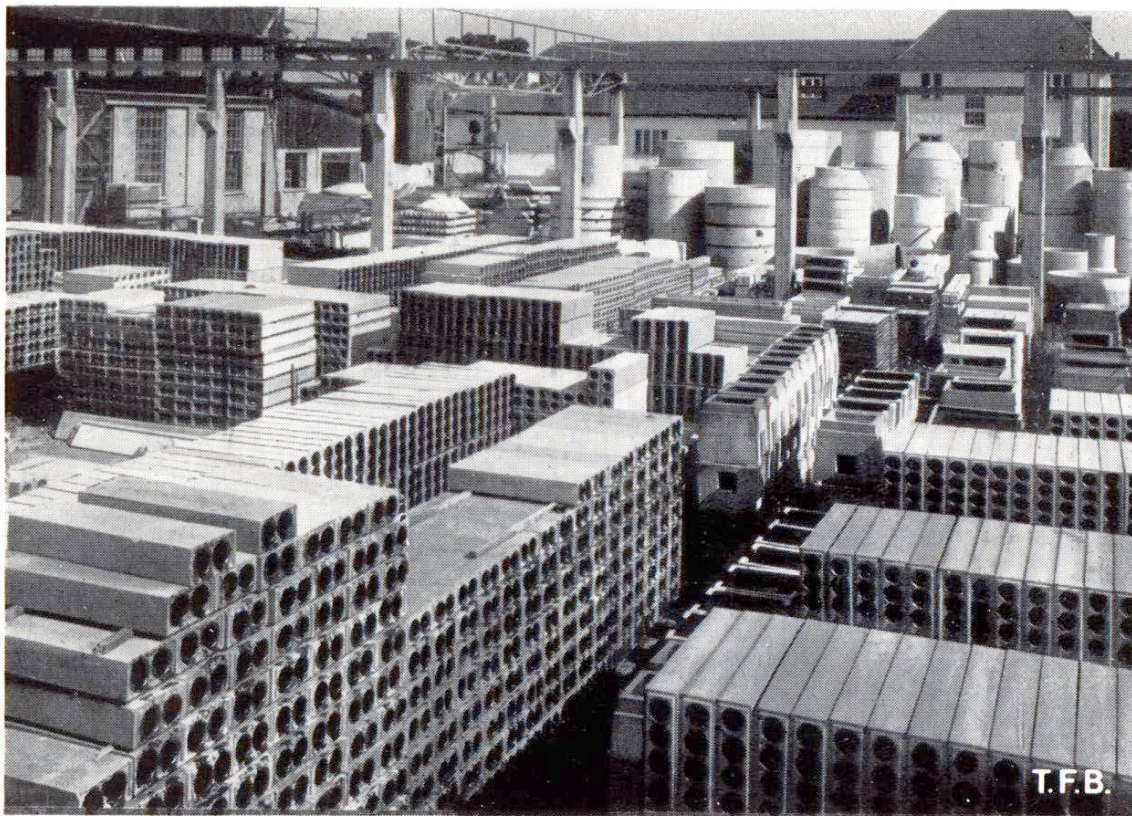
Dépôt de produits en ciment. Au premier plan, tuyaux de protection pour câbles
